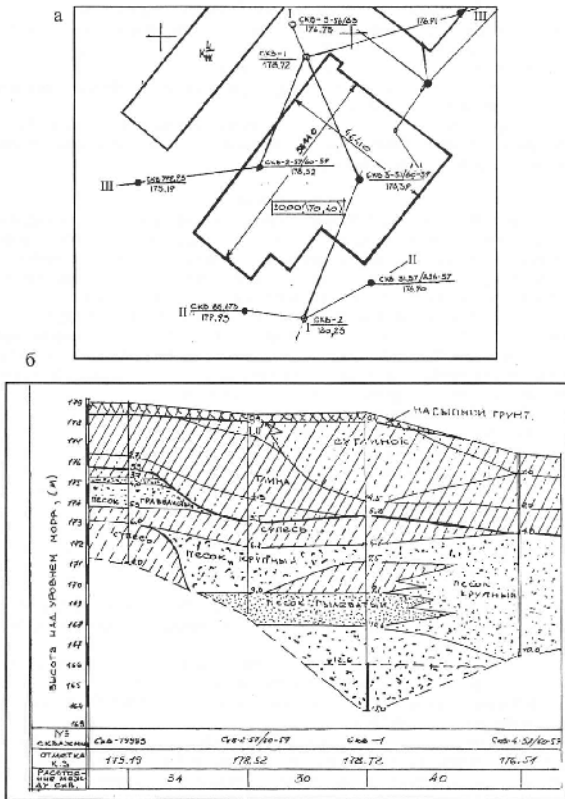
Геологическое строение площадки строительства: а – план площадки с нанесением схемы расположения скважины; б – геологический разрез по линии III – III
